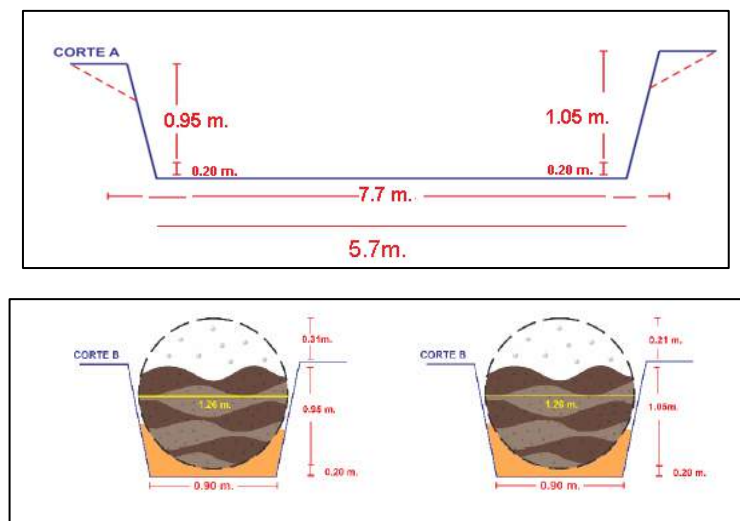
Dimensiones corte A y corte B de la zanja para el biodigestor tubular
